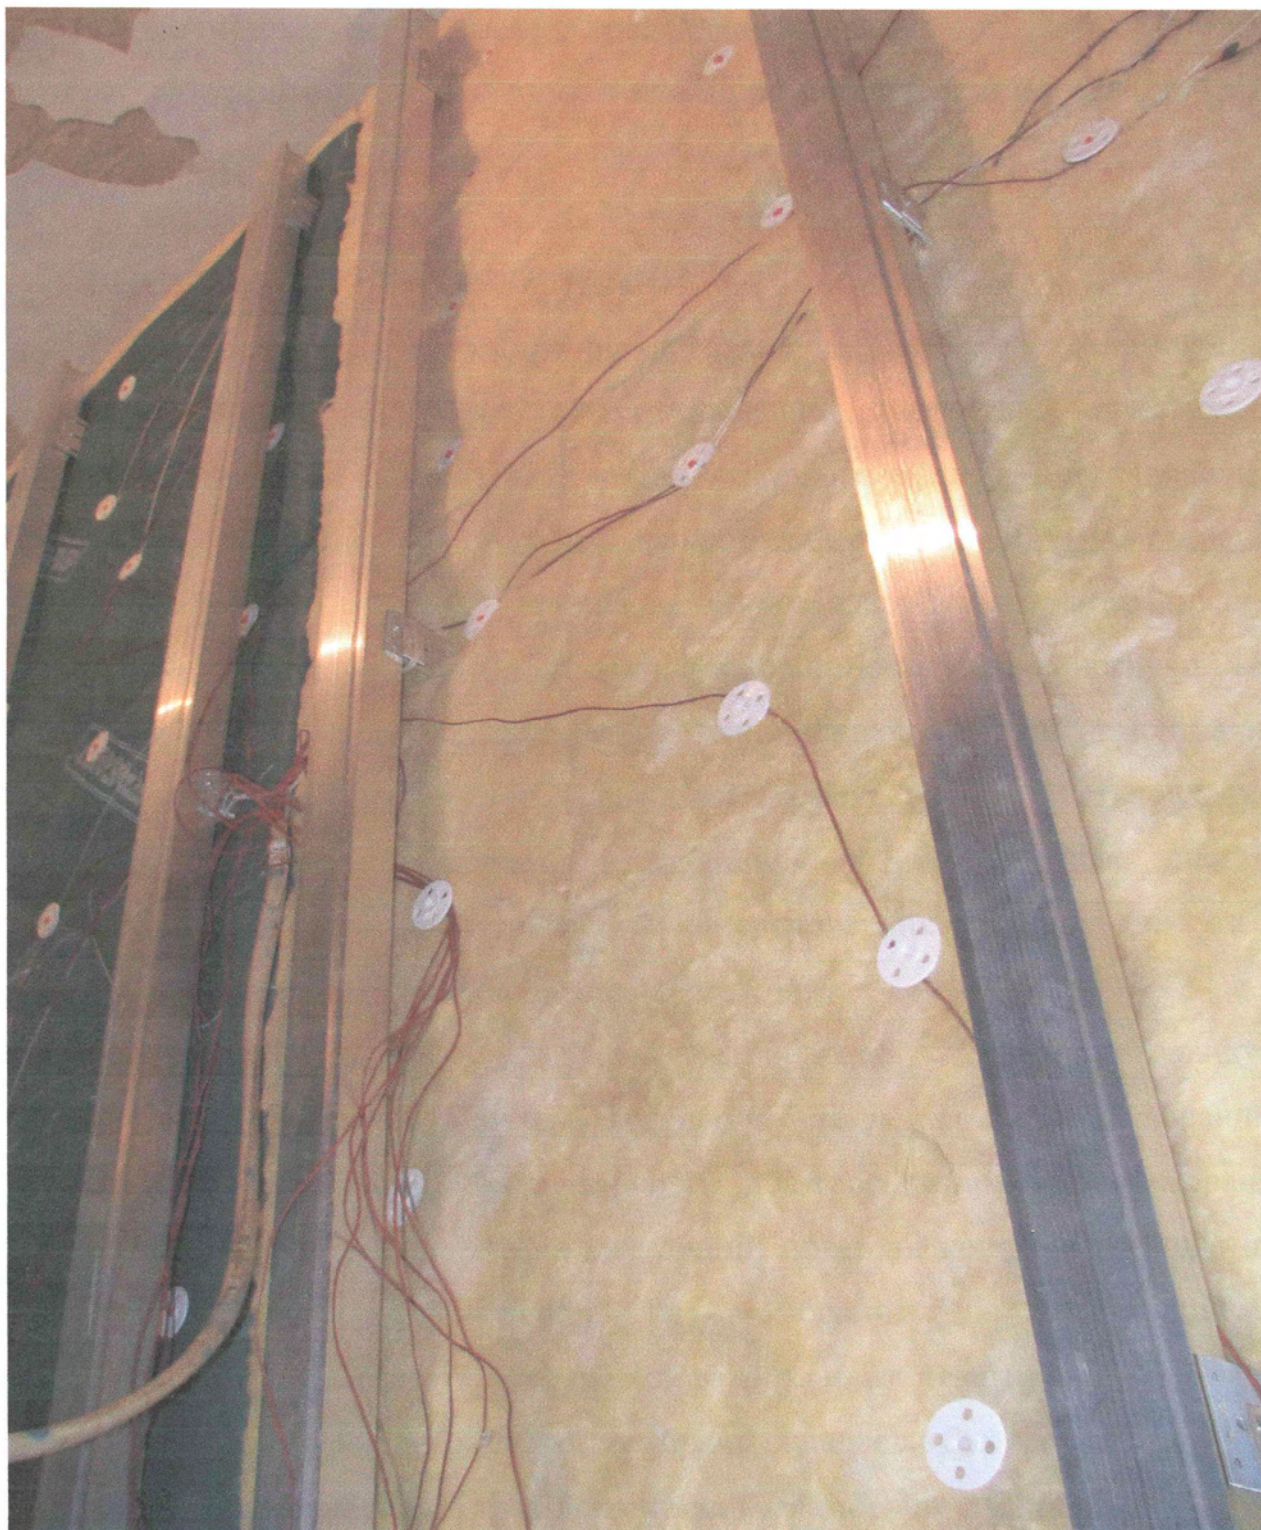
Вид зовнішньої поверхні утеплювача зразка № 3 в початковому стані.
